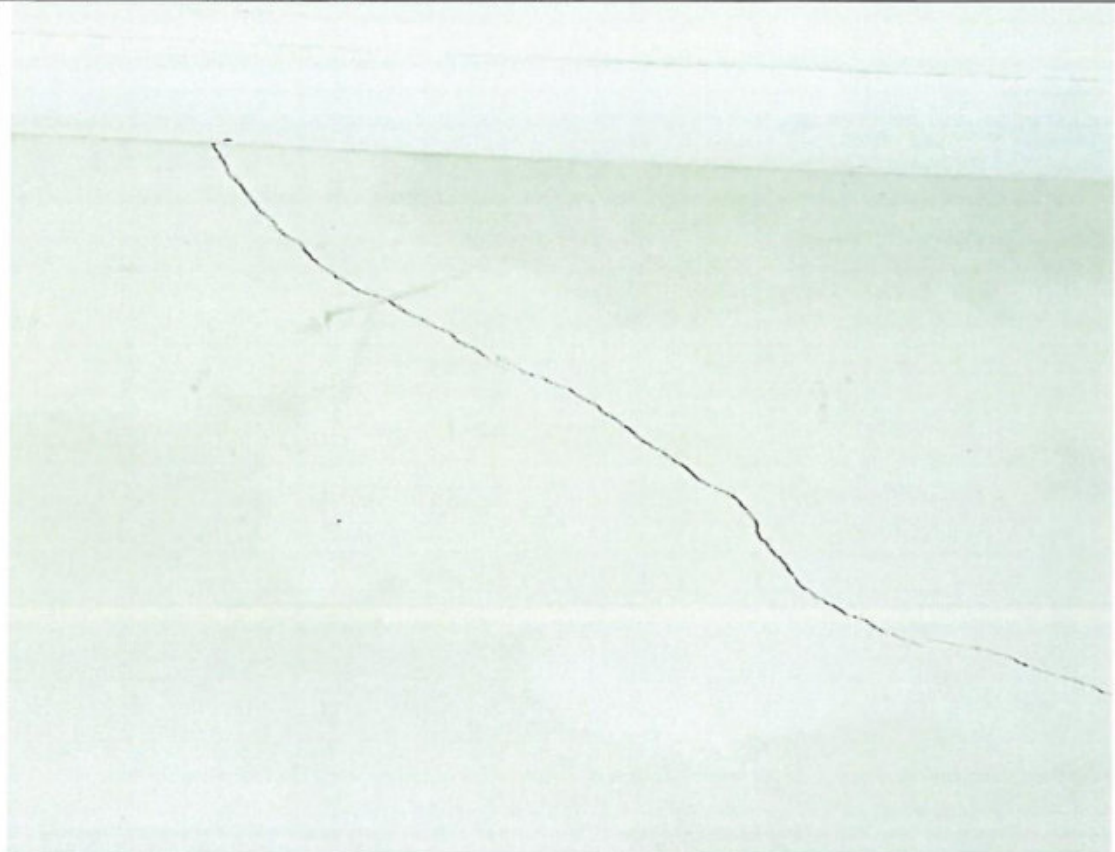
; raksturīga diagonāla plaisa ķieģeļu šķērssienai apmetumā
